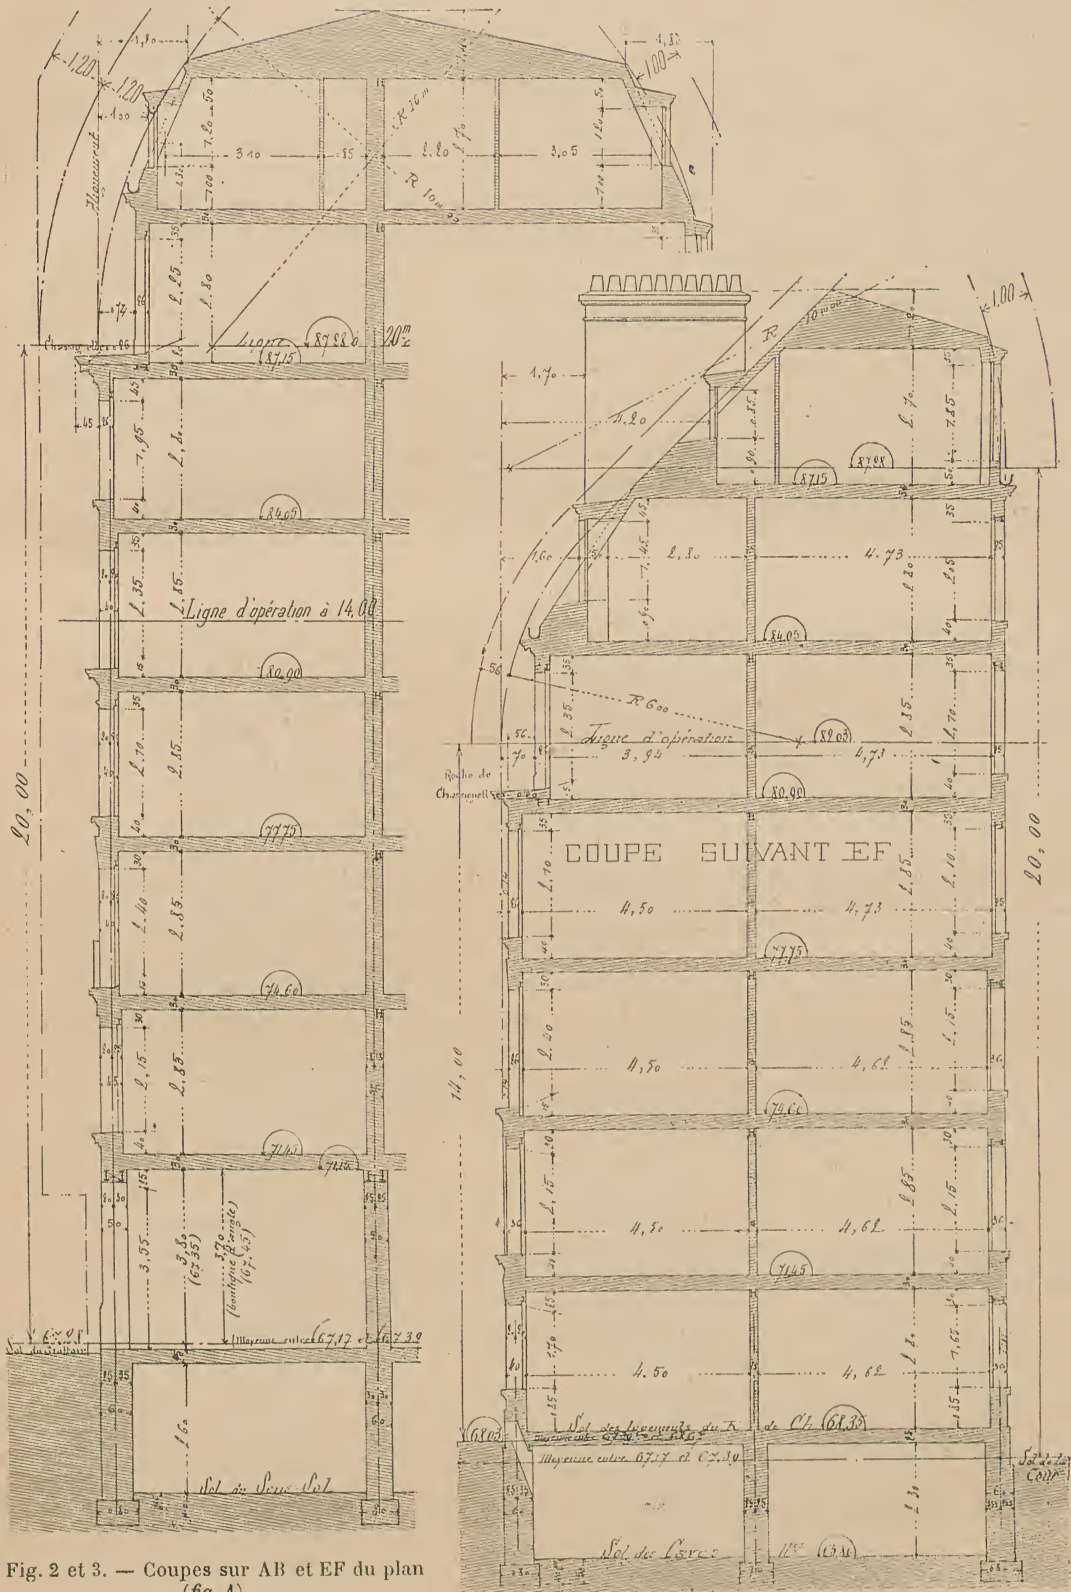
et 3. — Coupes sur AB et EF du plan (fig. 1).
